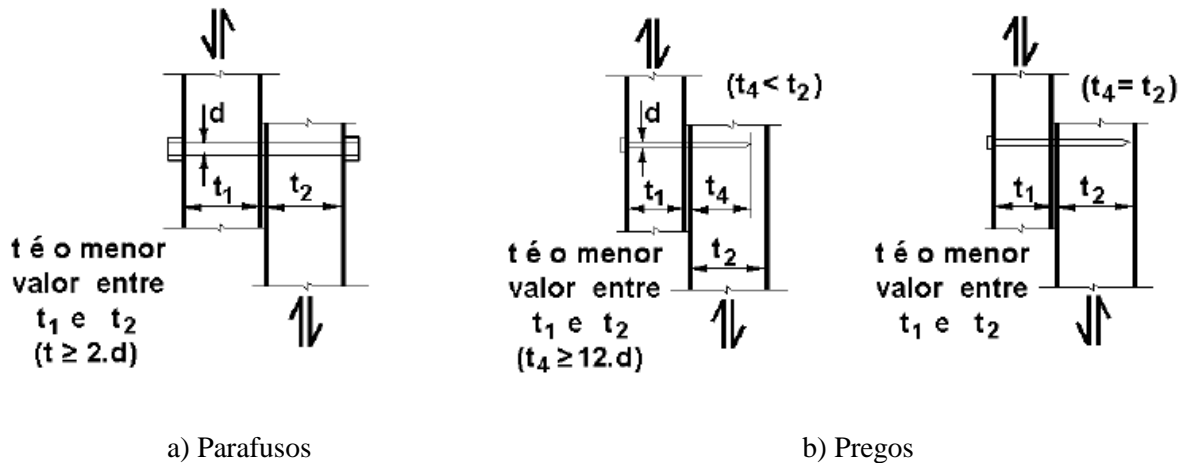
Elementos do tipo cavilha em corte simples [17].
